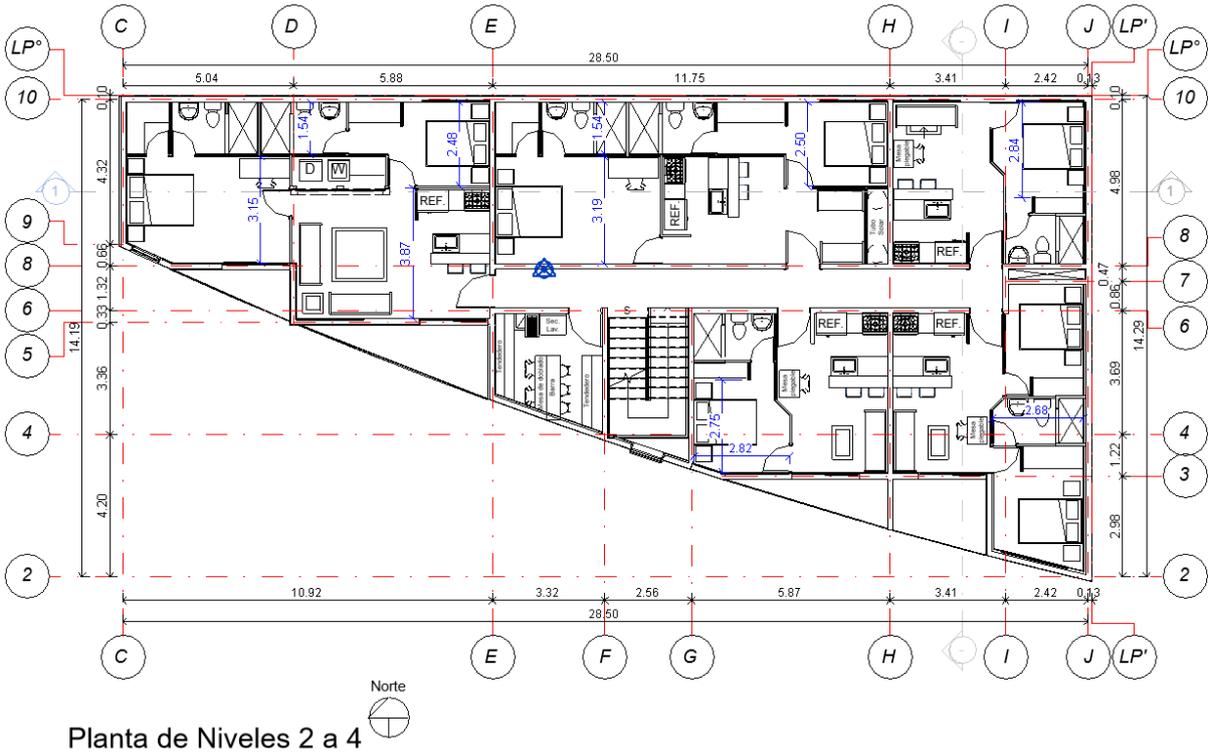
Planta de niveles 2 a 4 con estrategias
